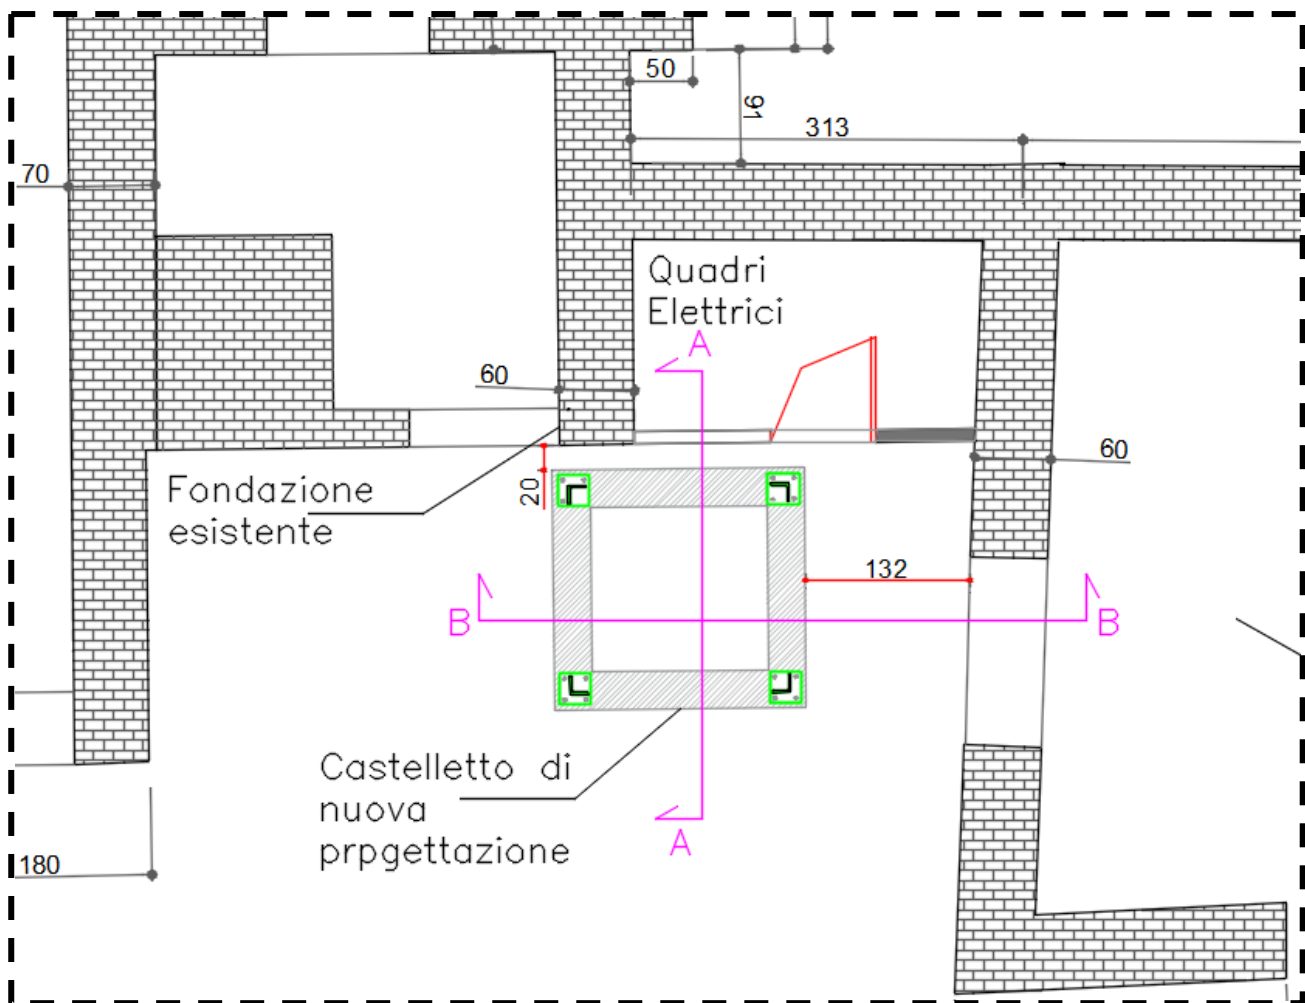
Vista in pianta posizionamento Castelletto in acciaio
